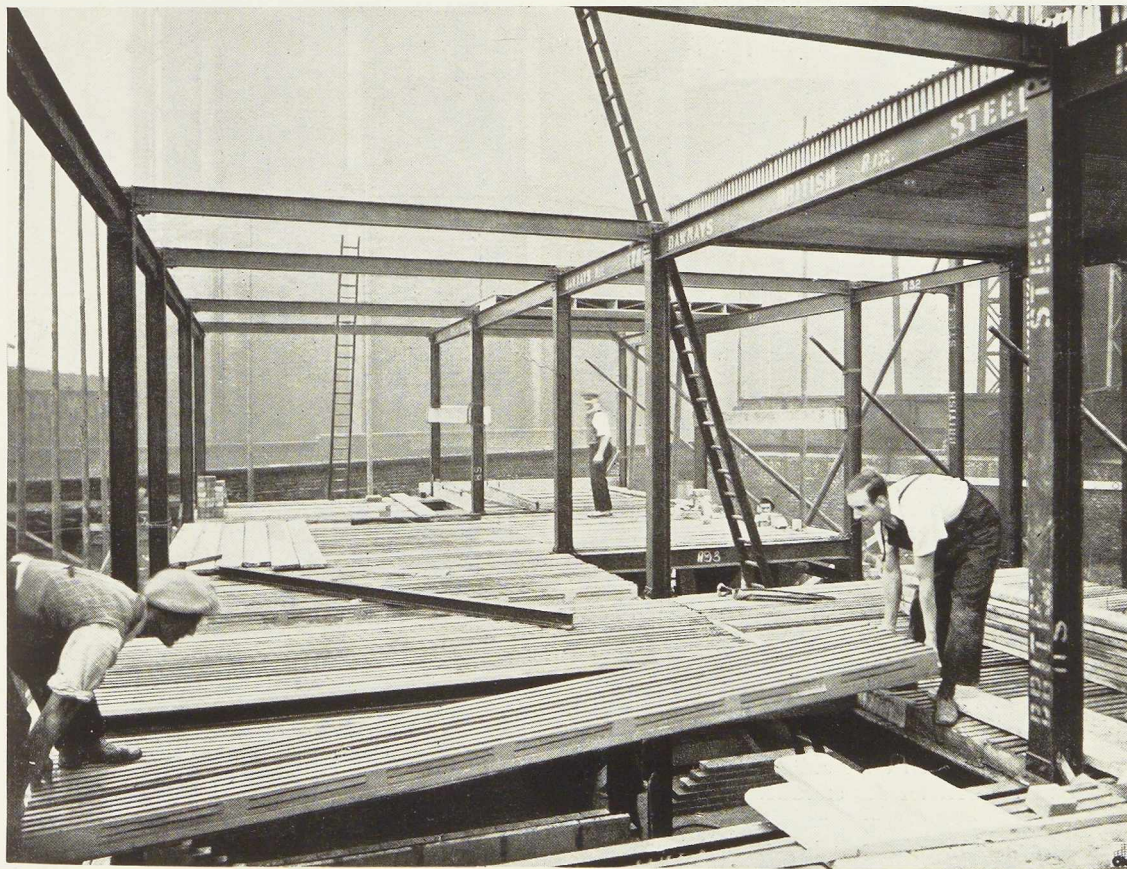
L'ossature est achevée, on note la simplicité des assemblages des poutres et colonnes. Les ouvriers procèdent à la pose des caissons en tôle pliée en queue d'aronde du plancher du 1^{er} étage. Ces caissons servent immédiatement de plancher de travail.
